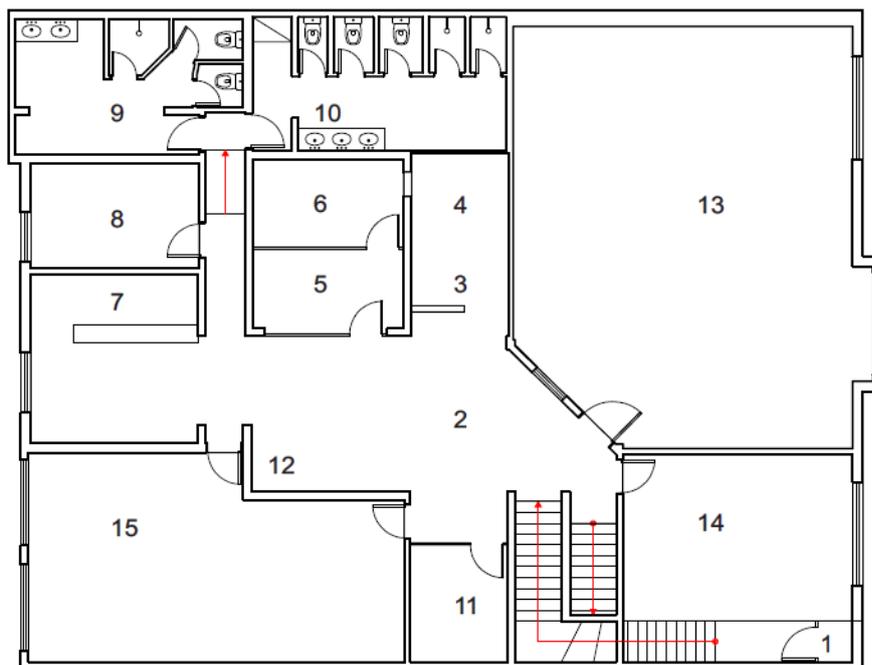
PLANTA PRIMEIRO PAVIMENTO – SEM ESCALA
